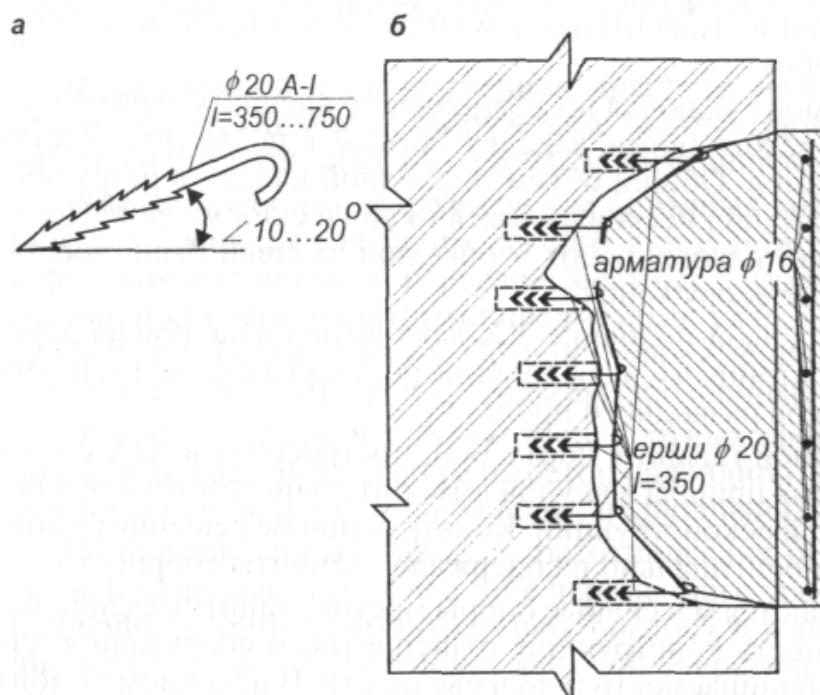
Підсилення з'єднання «нового бетону» зі старим анкерними елементами
